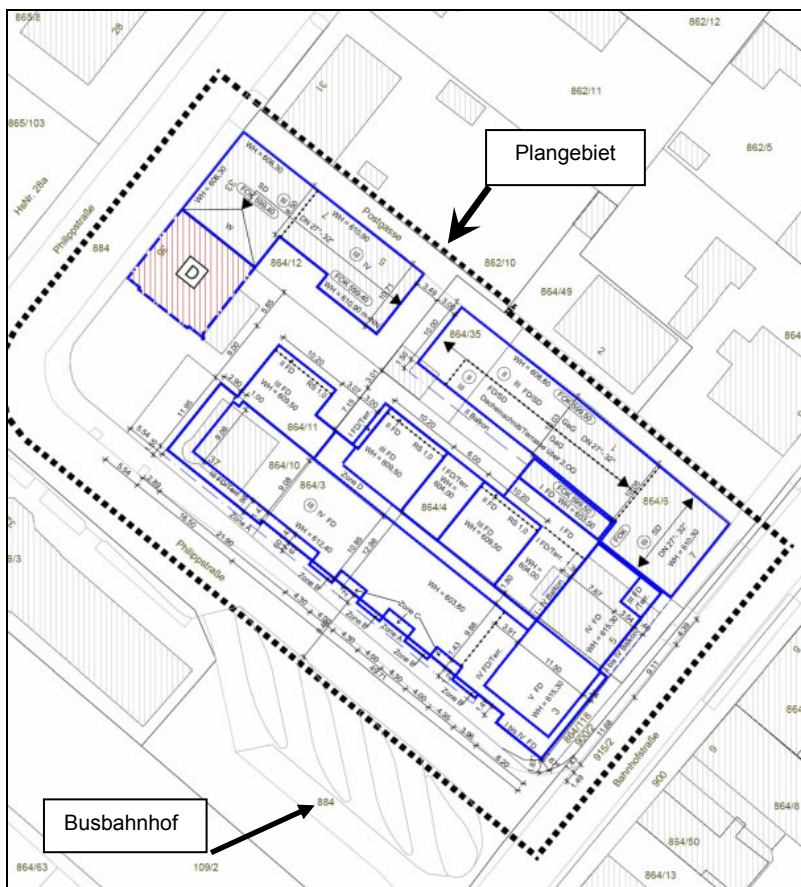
Bebauungsplan "Innenstadt VI", Obergeschosslagen
